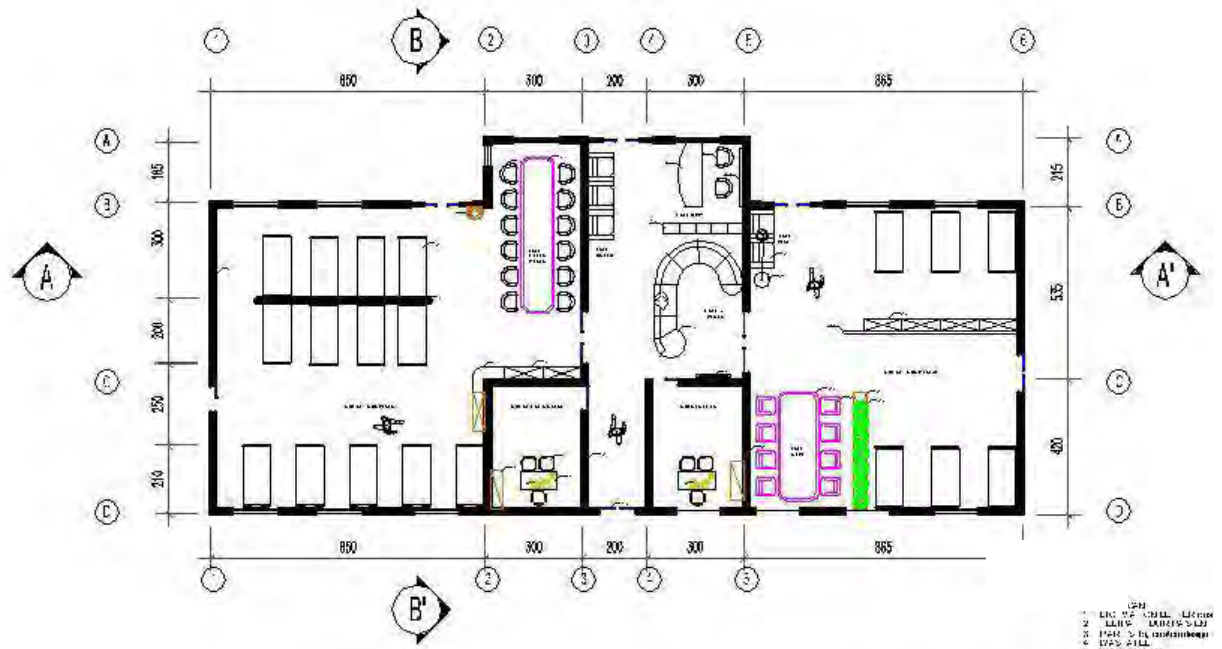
2 Denah Alternatif 1 R.Jalak
